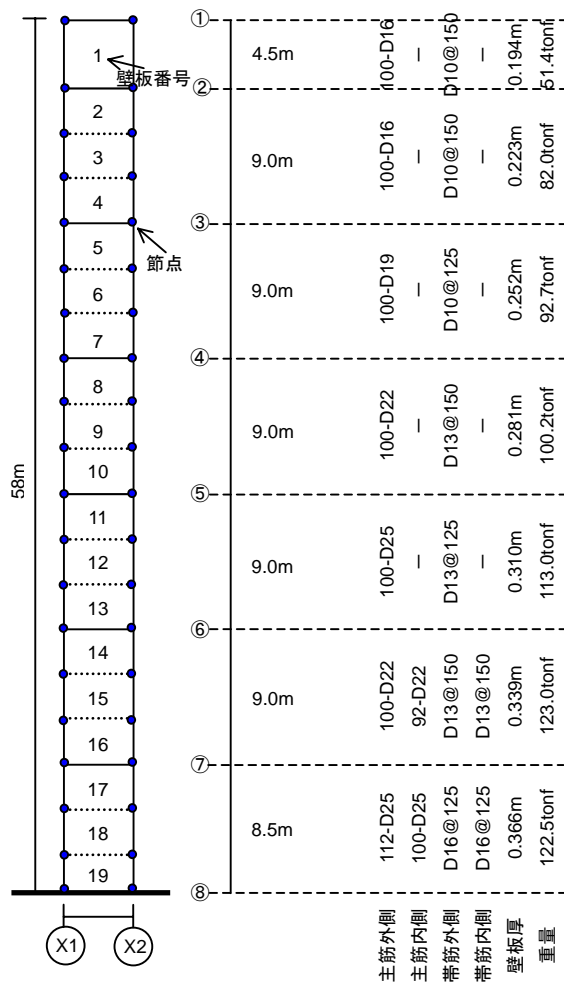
煙突の立面図 (Y1 構面) および配筋詳細
